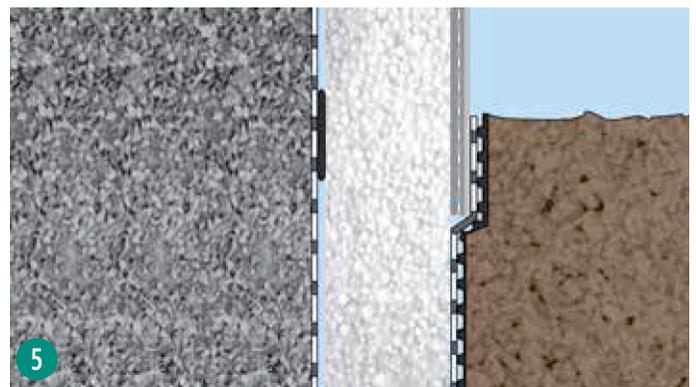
Colocados los paneles aislantes, capa base y revestimiento de acabado hasta la cota requerida para prevenir de humedades el sistema en toda la zona enterrada, colocar una barrera impermeable hasta la cota del suelo y protegerlo con una lámina de drenaje o capa antipunzonamiento.
